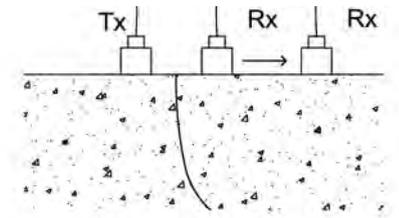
lectura de la orientación de fisuras/grietas en el hormigón.
